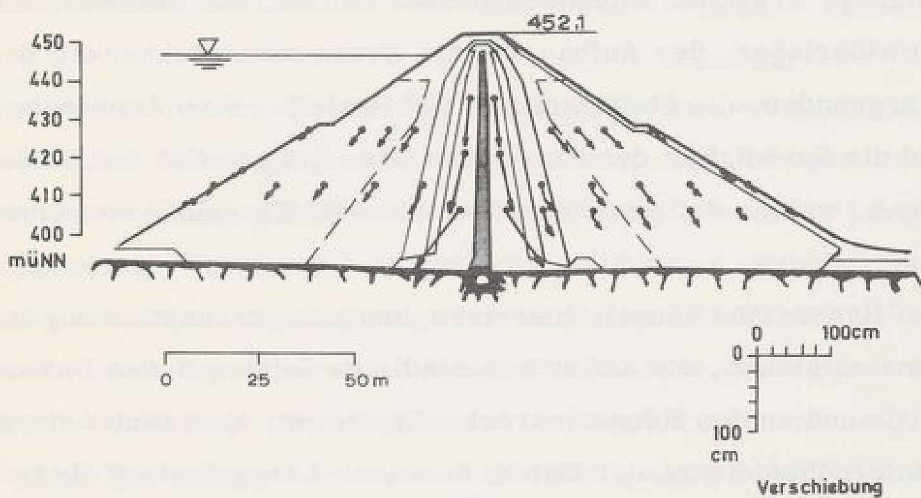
MAUTHAUS Damm, Verschiebungsvektoren einiger Meßpunkte im Bauzustand, LORENZ (1973)
